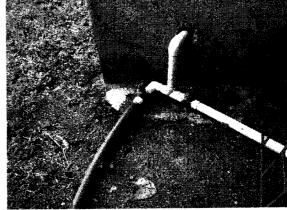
y 2: Pozo construido en tubería de 6" en RDE 26 con 2 llaves de control a la salida.
